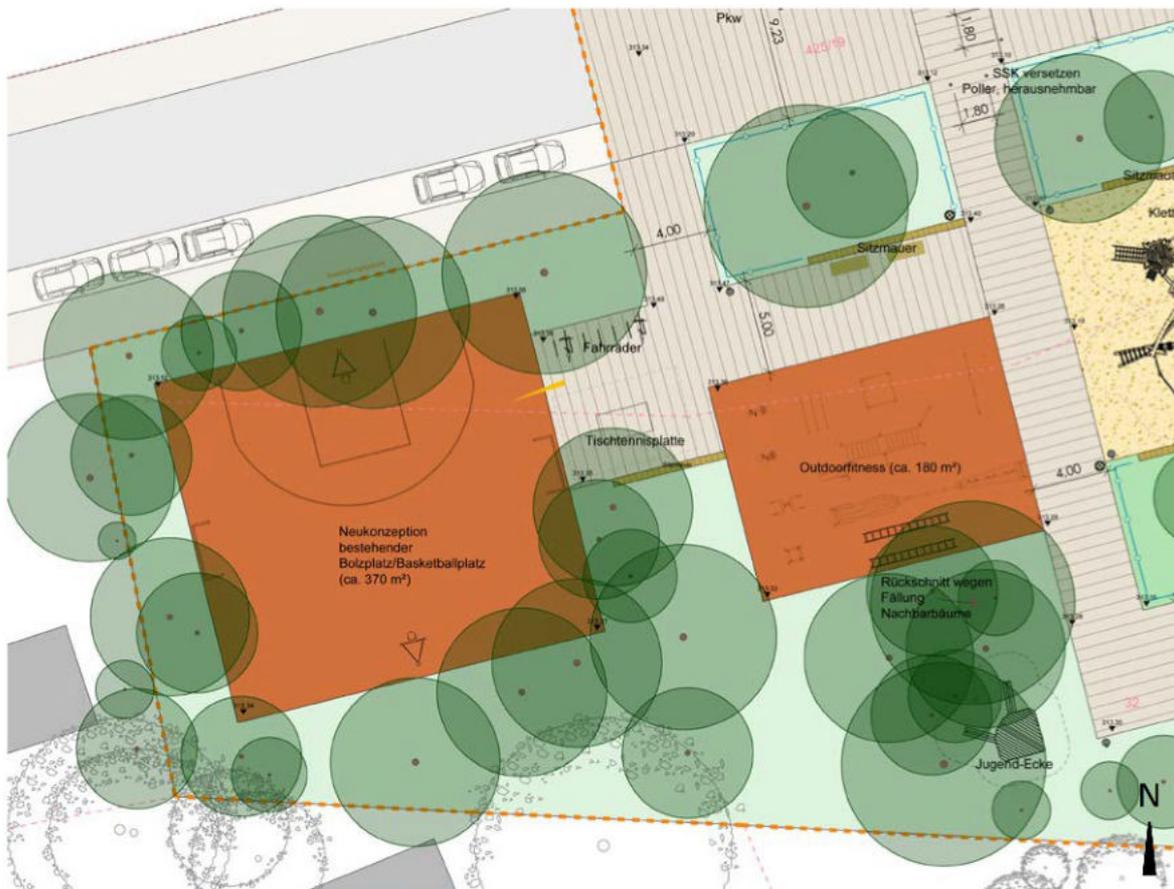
Lageplanausschnitt Entwurf Sportbereich
